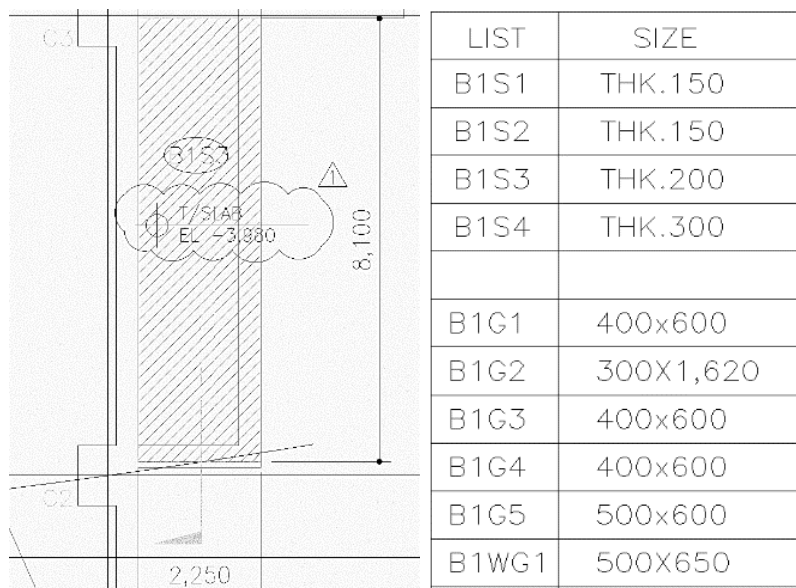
Dalle pleine en BA et épaisseurs de quelques éléments structuraux situés dans le 1er sous-sol
